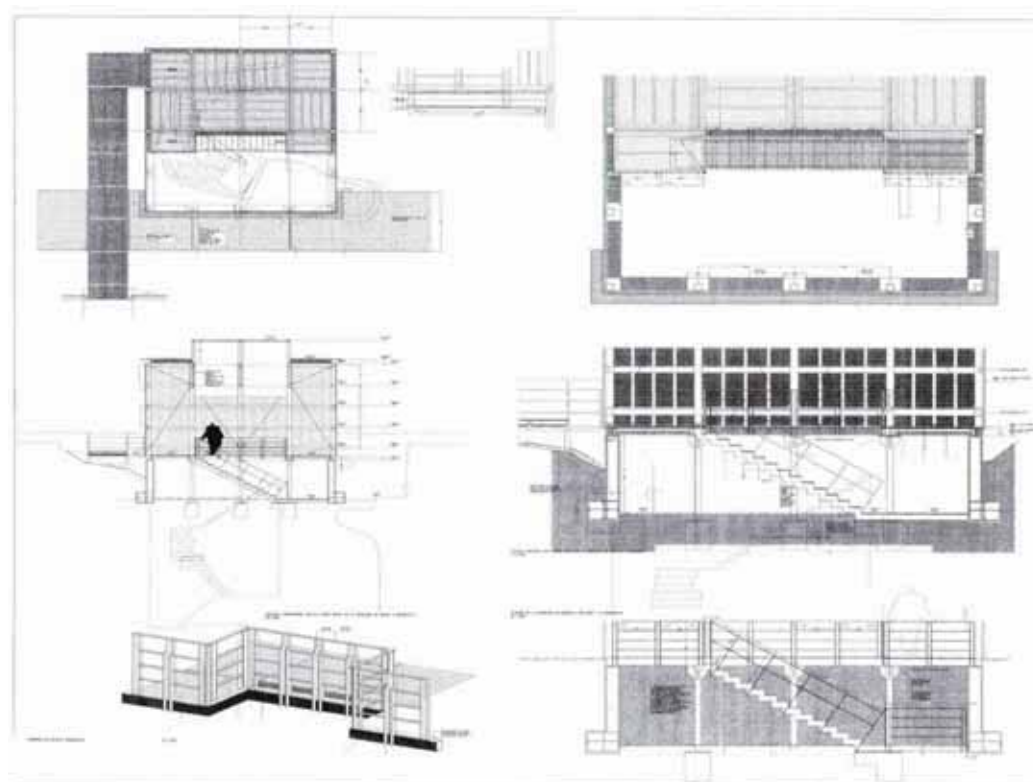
Planimetría del pabellón de acceso a las estructuras subterráneas
